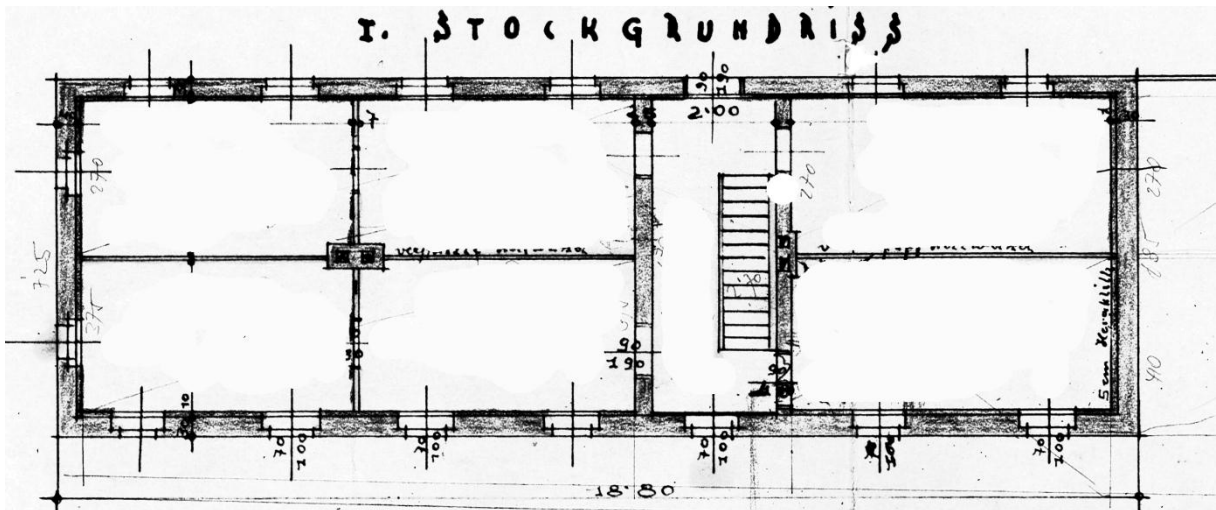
Grundriss Obergeschoß (Bestand)
